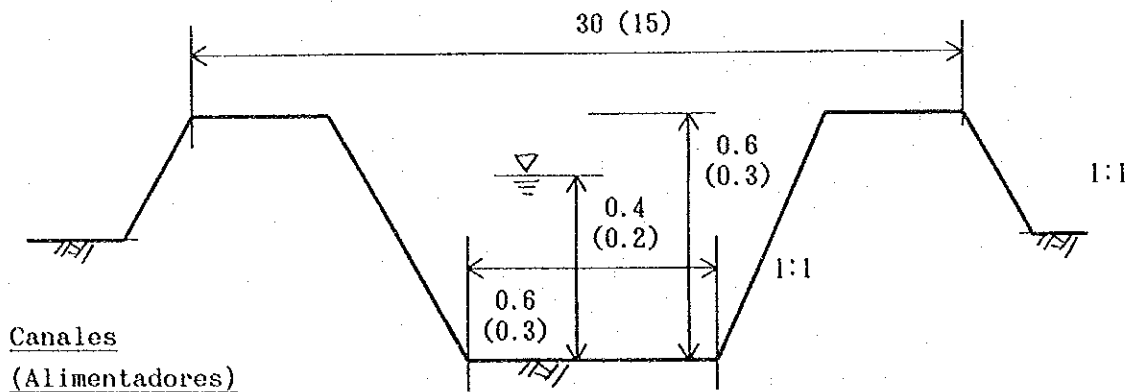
Canal secundario (para zonas situada al norte
